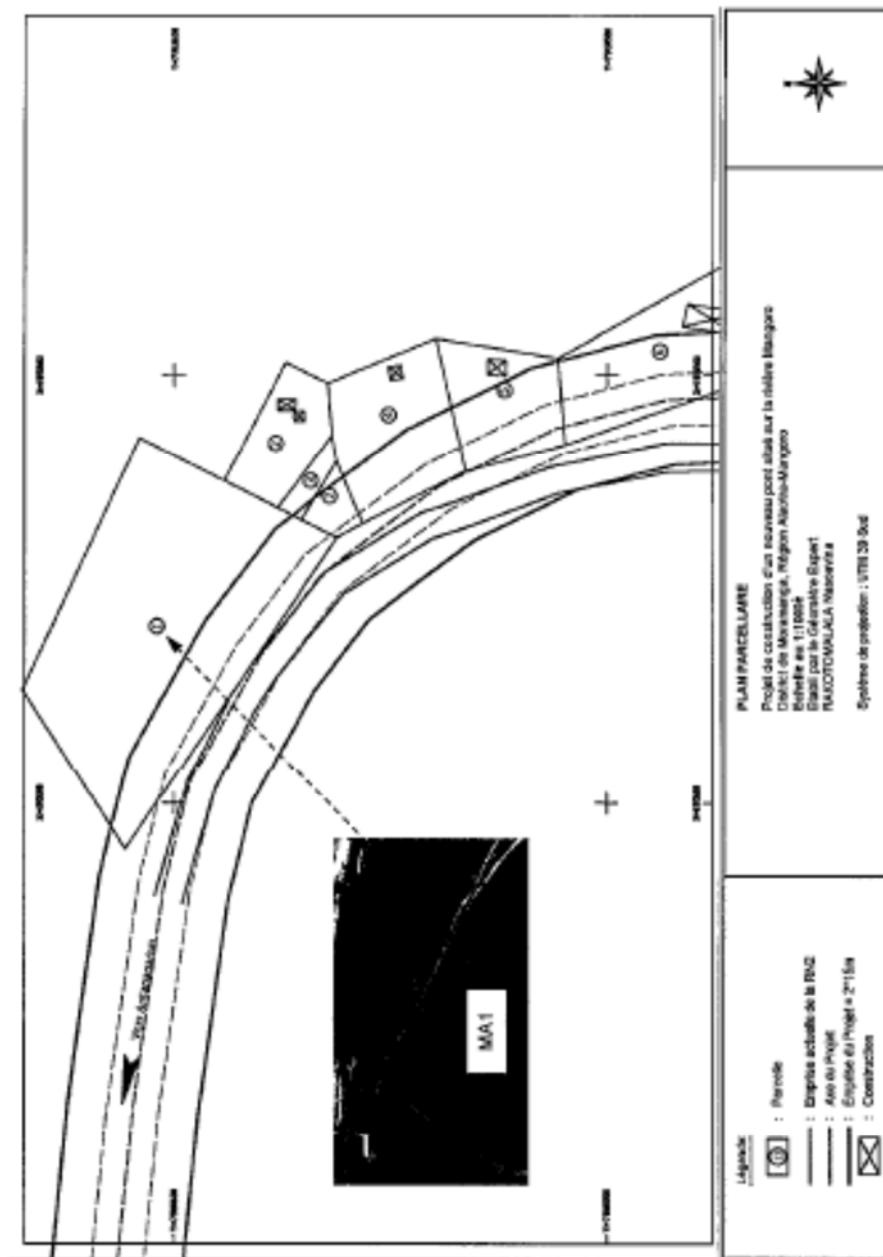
PLAN PARCELLAIRE - MANDORD 1
